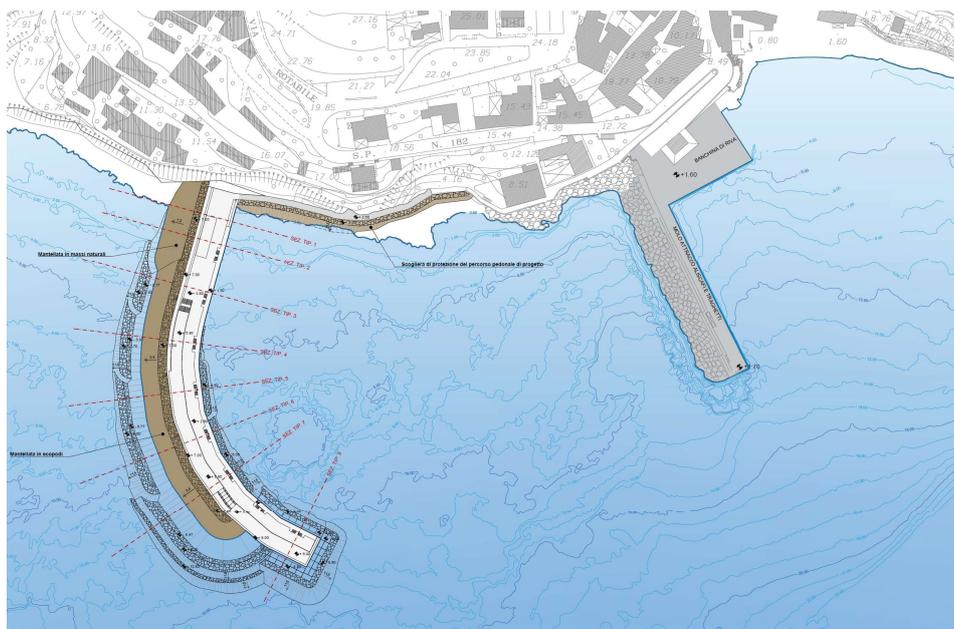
Stralcio Planimetria di Progetto – Progetto Definitivo di 1^ Stralcio Funzionale
